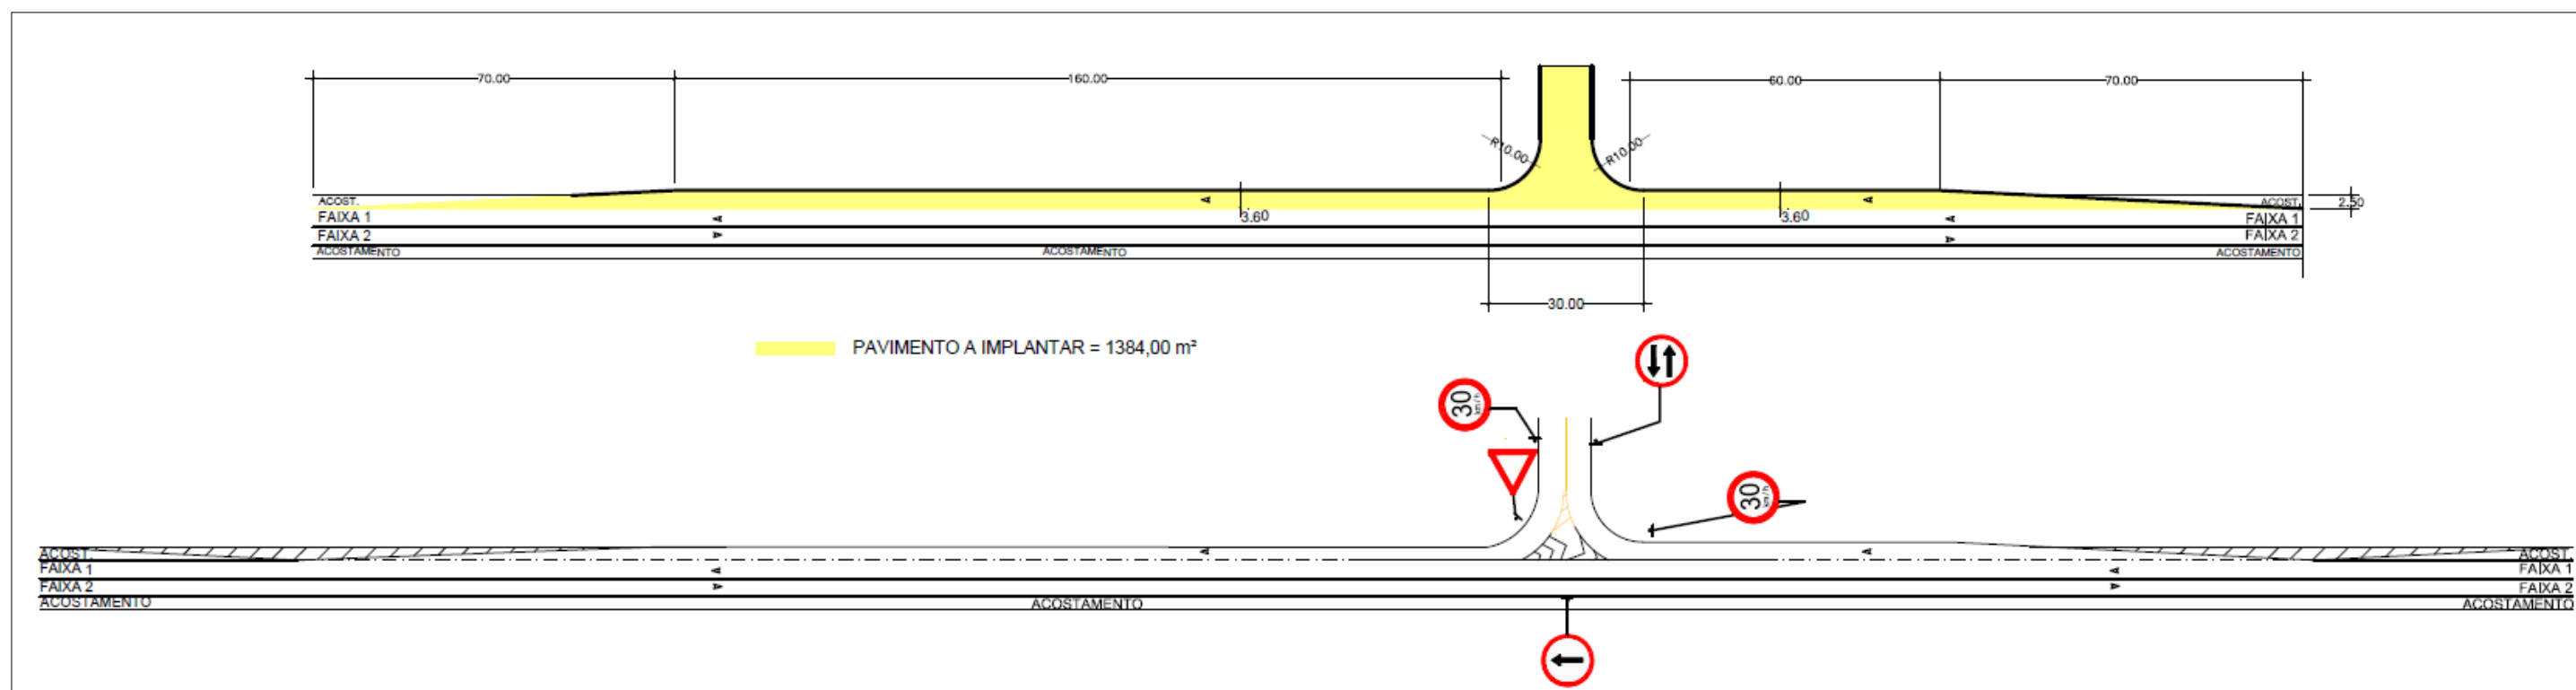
Acesso Tipo 2 – Geometria / Pavimentação e Sinalização.
